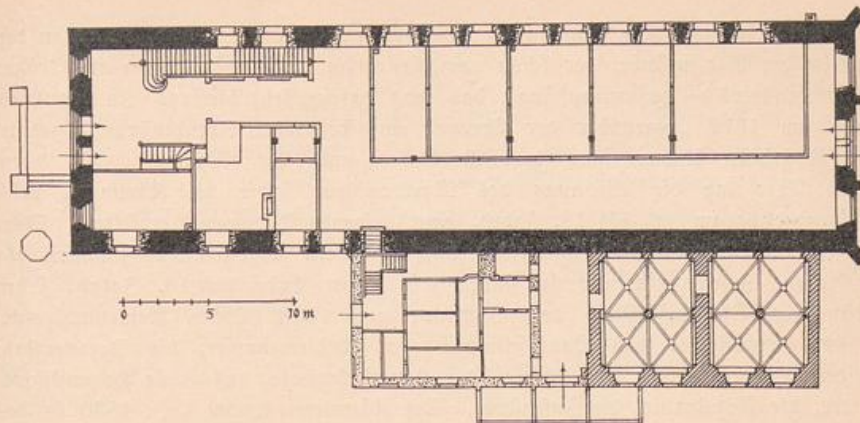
Erdgeschoßgrundriß des Neustädter Rathauses (vor dem Umbau).
